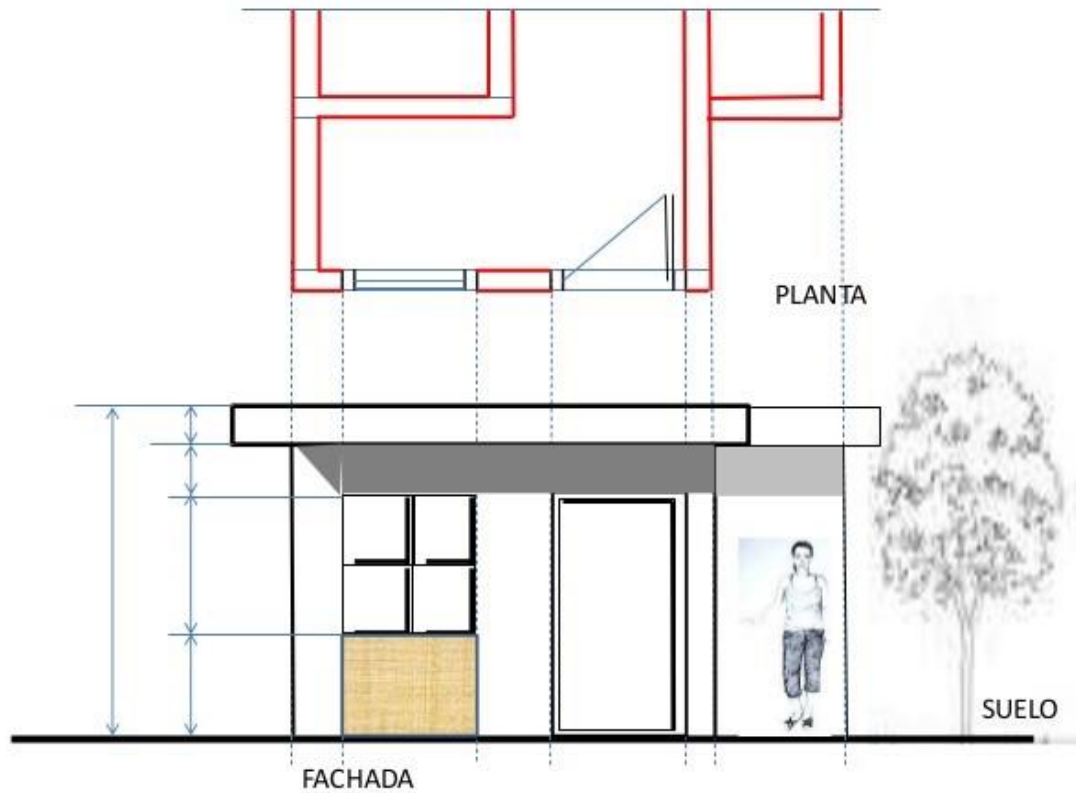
Proyección ortogonal desde la planta arquitectónica para generar fachada
